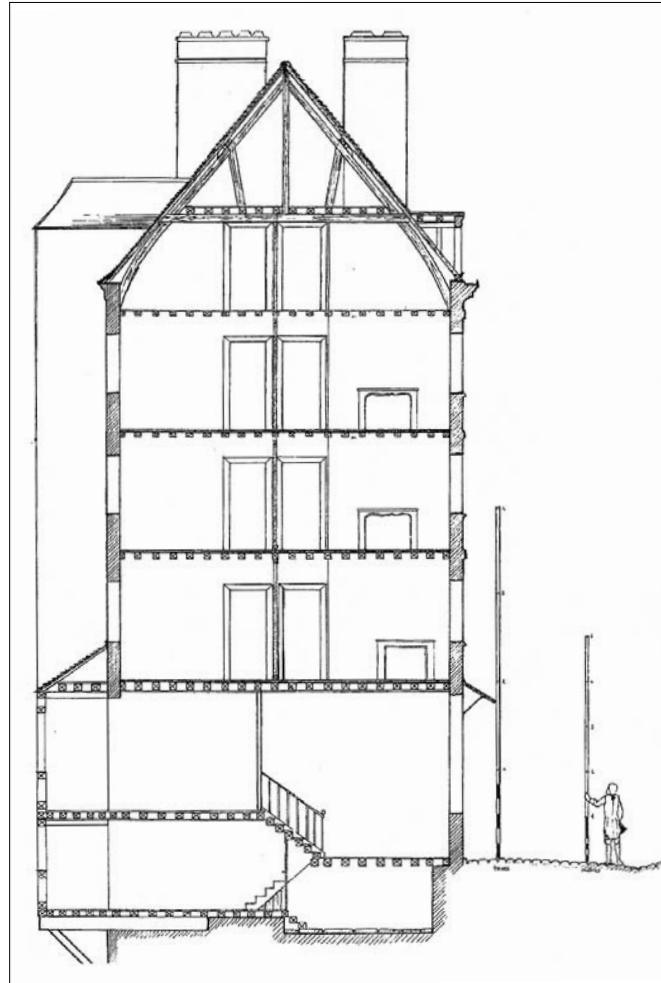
Sezione-tipo di una casa sul ponte: vi si ritrova in particolare la divisione in due parti dei piani, il raddoppio del piano terreno dalla parte della Senna ed i gabinetti a sbalzo. Questa sezione è valida per tutte le case dei ponti parigini, salvo quelle del ponte Notre-Dame che presentano un frontone sulla strada.
